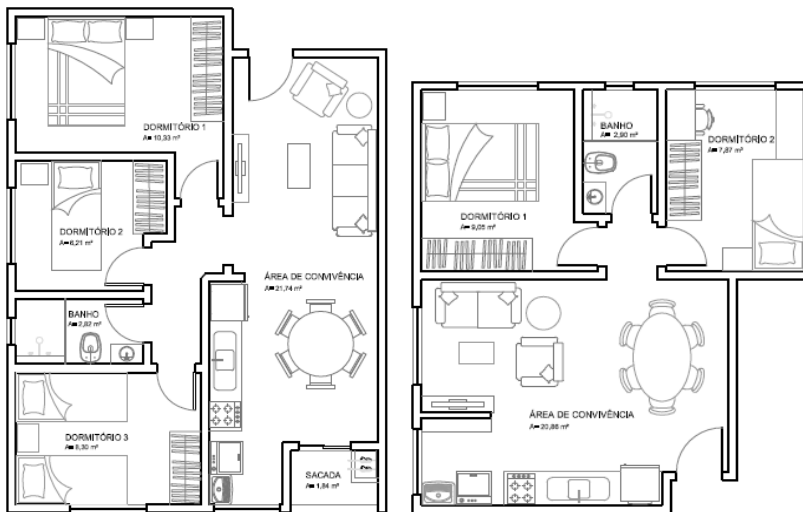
a) Planta baixa da habitação Tipo A. b) Planta baixa da habitação Tipo B.
